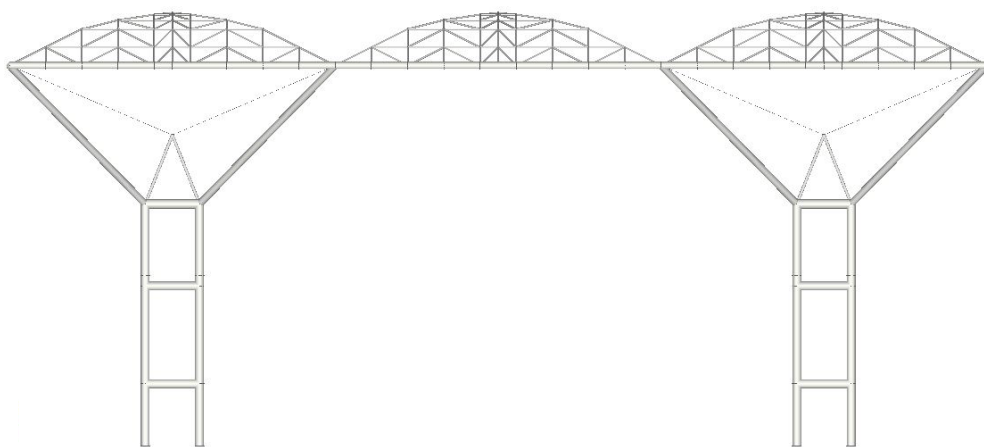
Modelo 3D | Alzado de la estructura metálica
